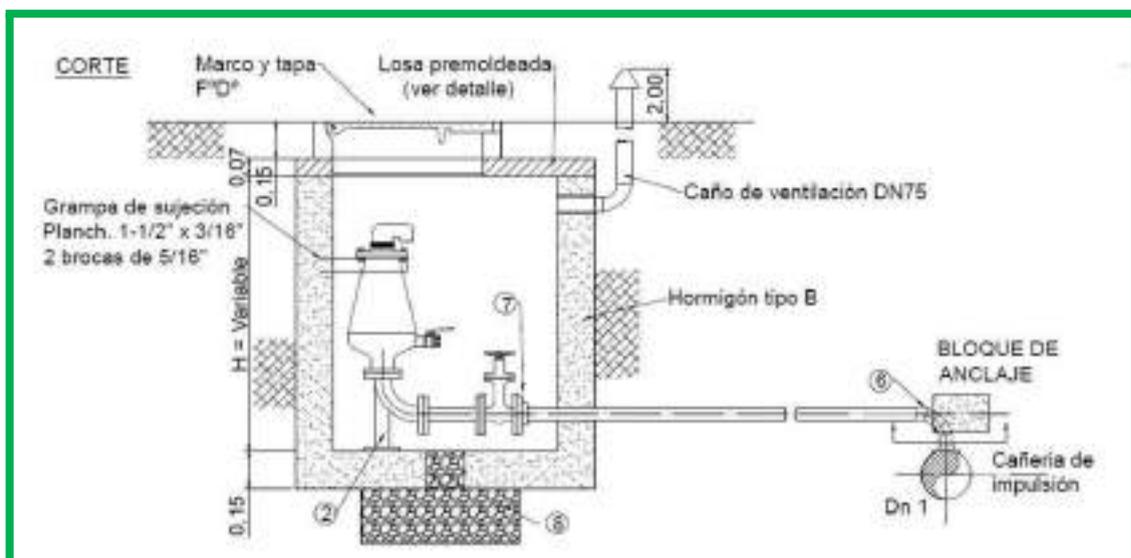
VISTA DE CORTE DEL PLANO DE LA UNIÓN DE LA CAÑERÍA DE IMPULSIÓN CON LA ESTACIÓN DE BOMBEO¹²
